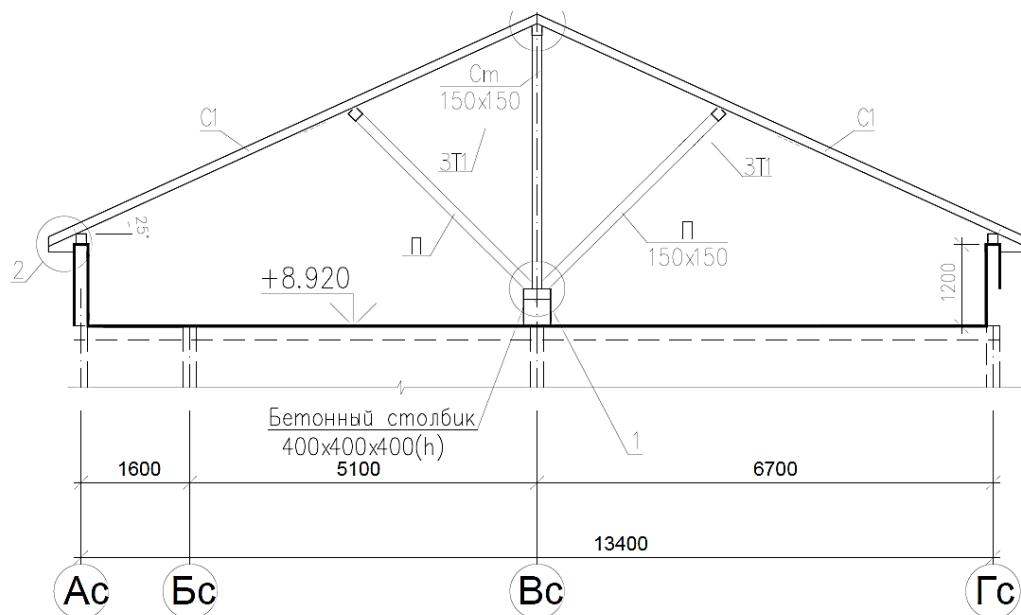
Схема конструктивного решения стропильной конструкции фрагмента покрытия
